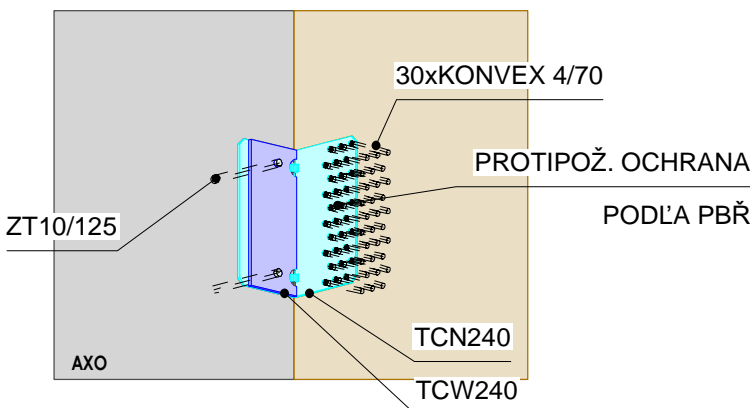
DETAIL "C" - PRIPOJENIE STENOVÝCH
